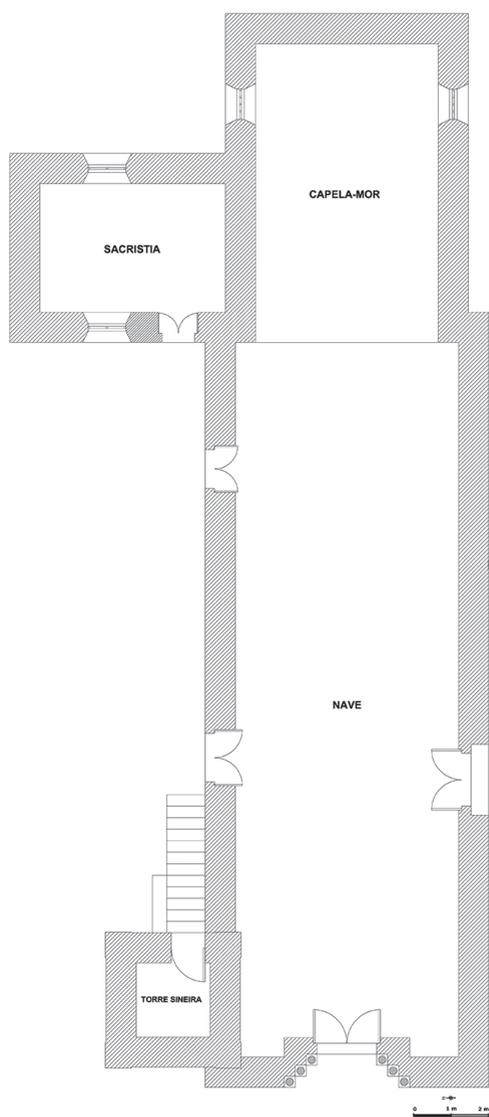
Planta da Igreja do Salvador de Aveleda (Câmara Municipal de Lousada, 2010).
